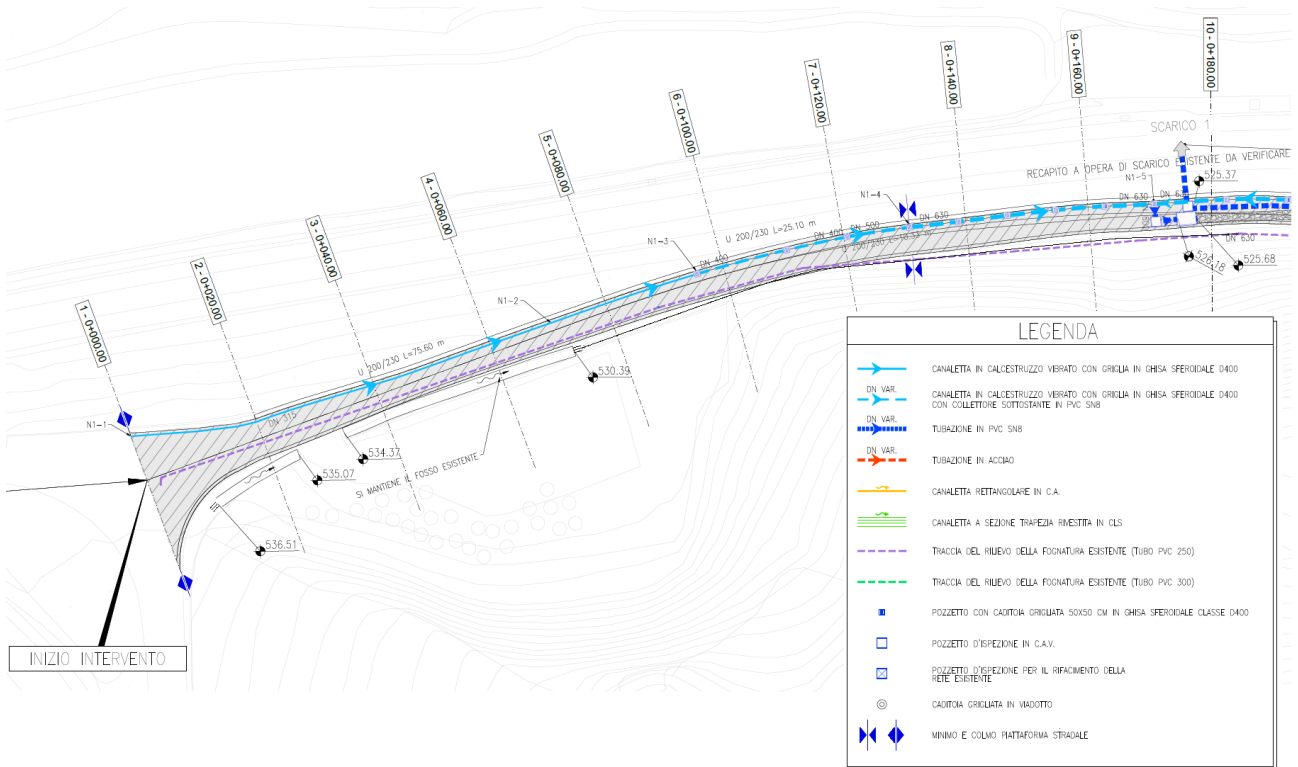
Estratto dalla "Planimetria idraulica" di progetto esecutivo (codifica: IBOU1BEZZP8NV0420001)
